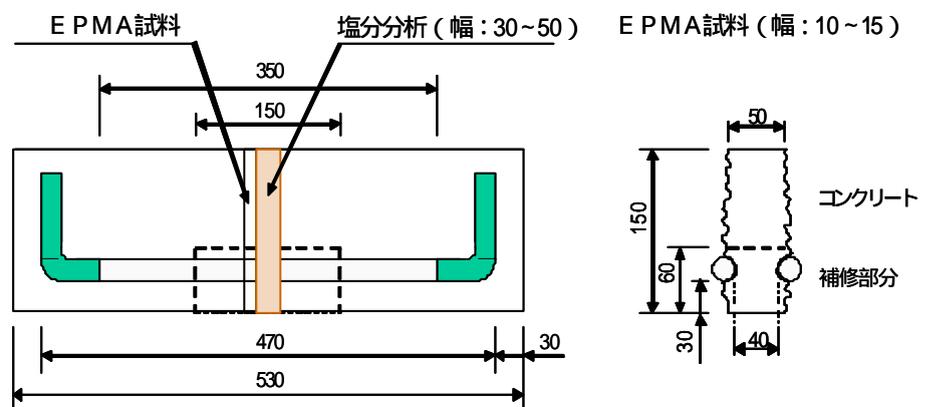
試験体の形状とEPMA 試料の採取位置ならびに寸法 (単位 mm)
